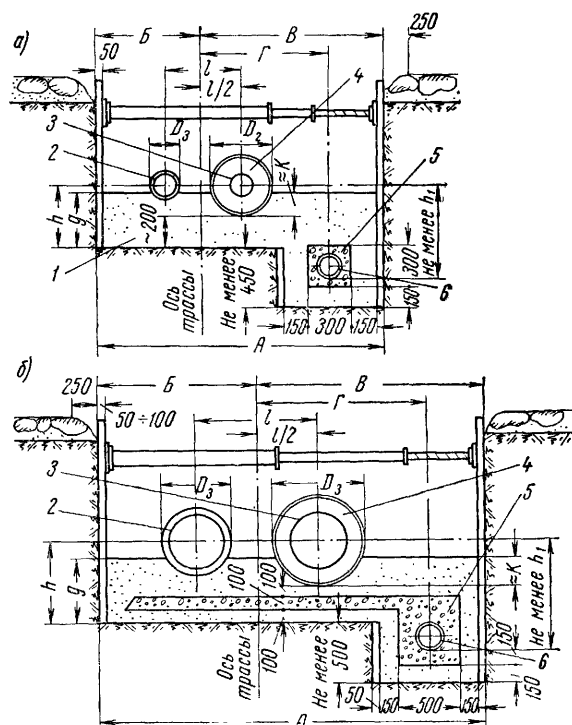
Сечение бесканальной прокладки тепловых сетей в мокрых грунтах (размер по табл. 15.21)
